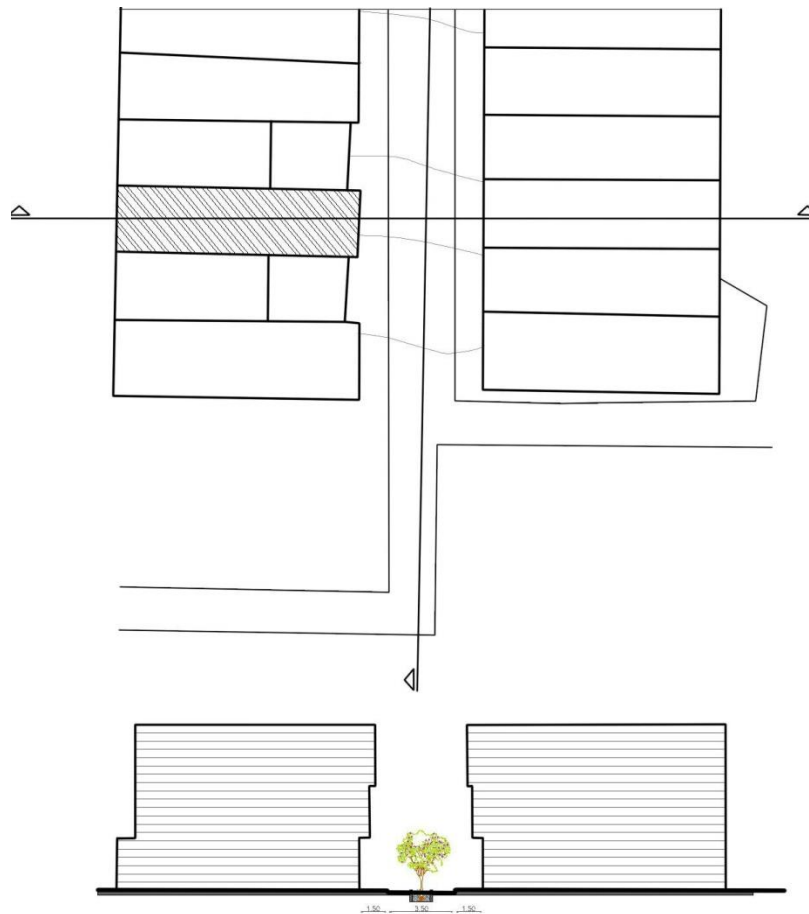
Planta y perfil de la manzana donde se ubica la vivienda estudio.
